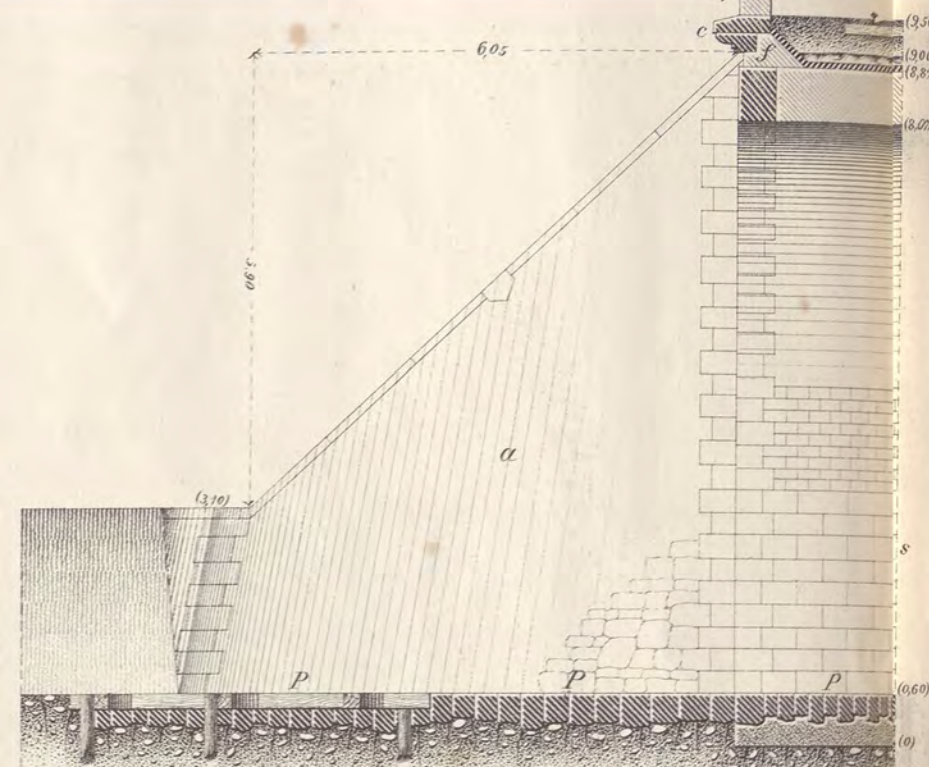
<sup>a</sup> Prospetto e sezione longitudinale del sottovia.
